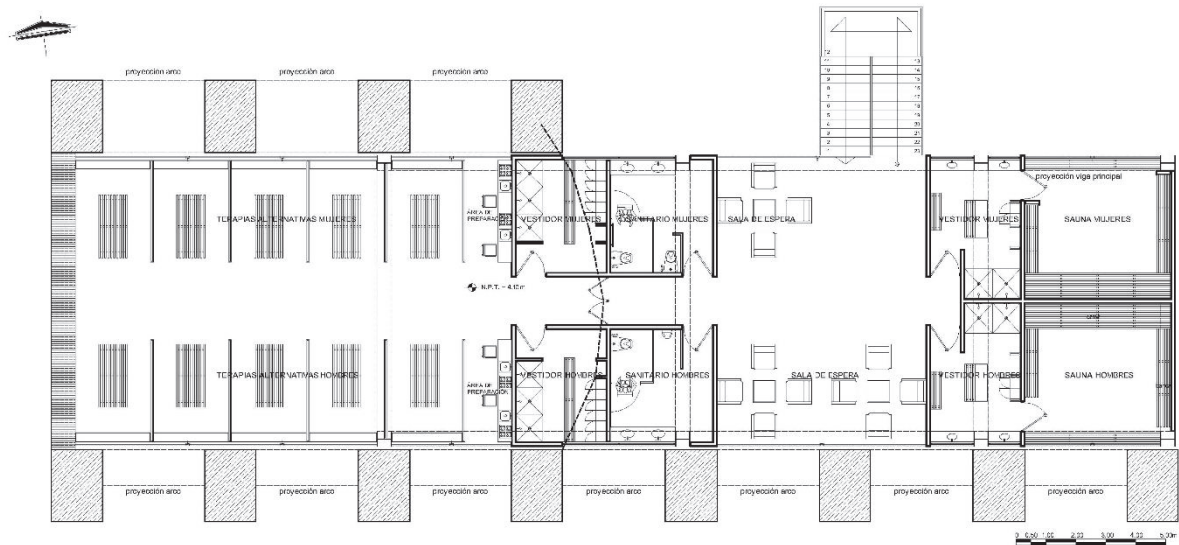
Planta alta arquitectónica para el nuevo uso propuesto para el trapiche convertido en spa.
